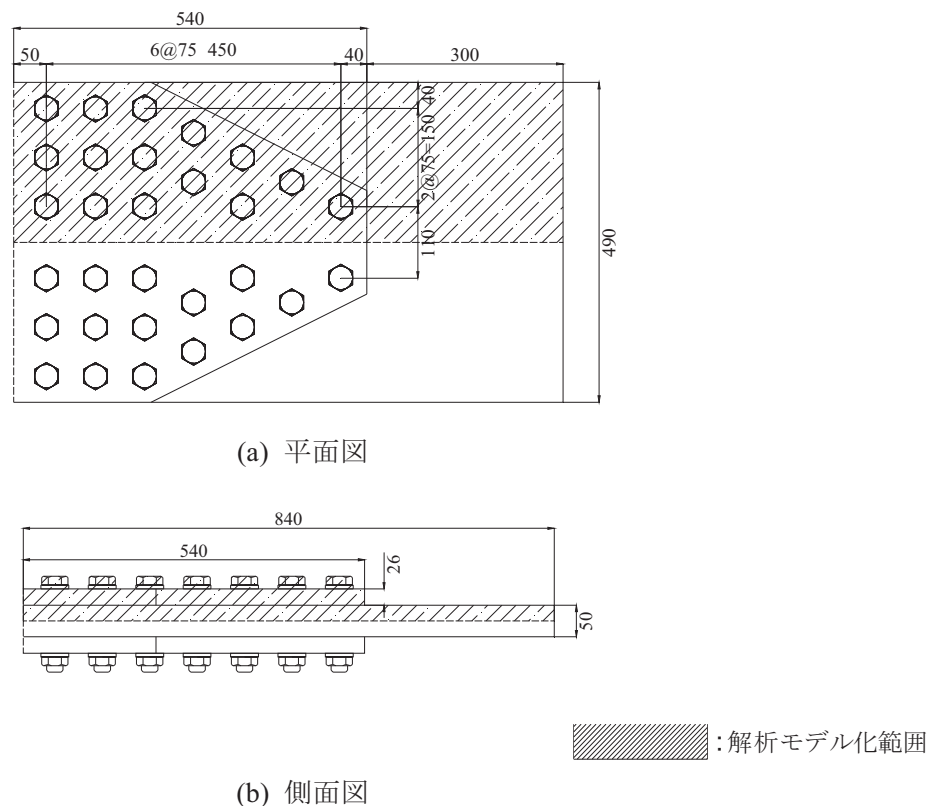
解析モデルのモデル化範囲 (単位 : mm)
